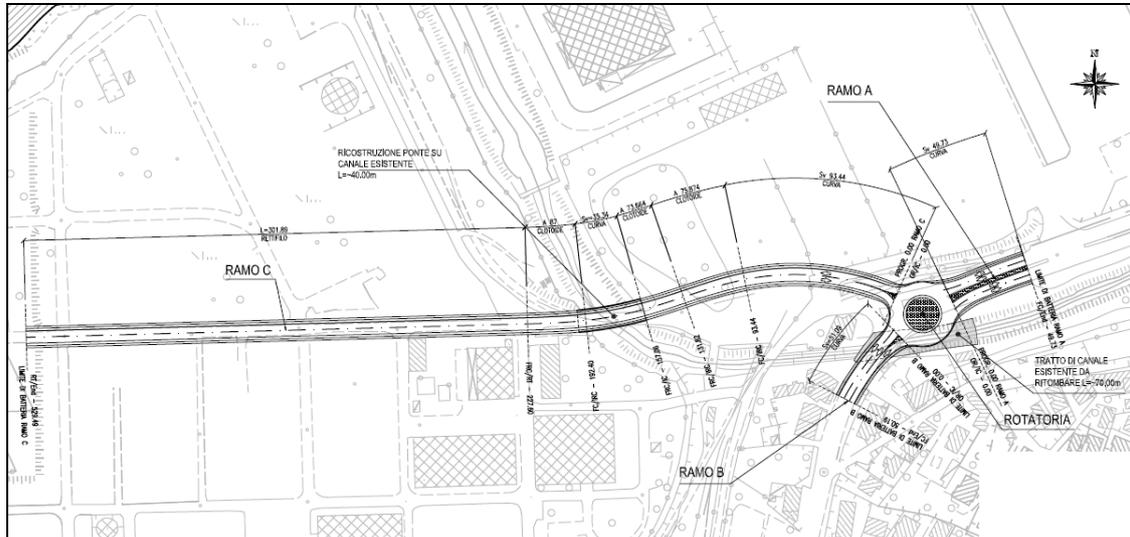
PLANIMETRIA DEL COLLEGAMENTO STRADALE CON IL TERMINAL NOGHÈRE
